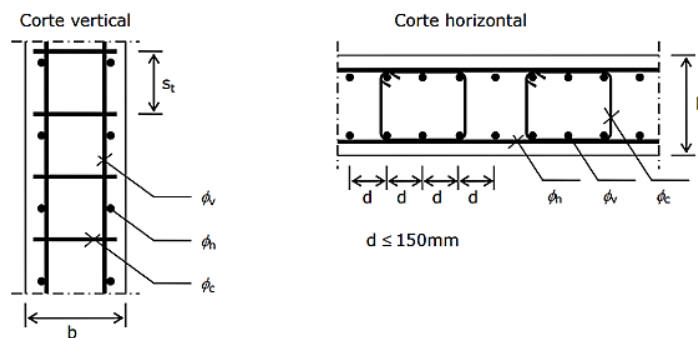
Esquema da armadura transversal (Félix, et al., 2014)
